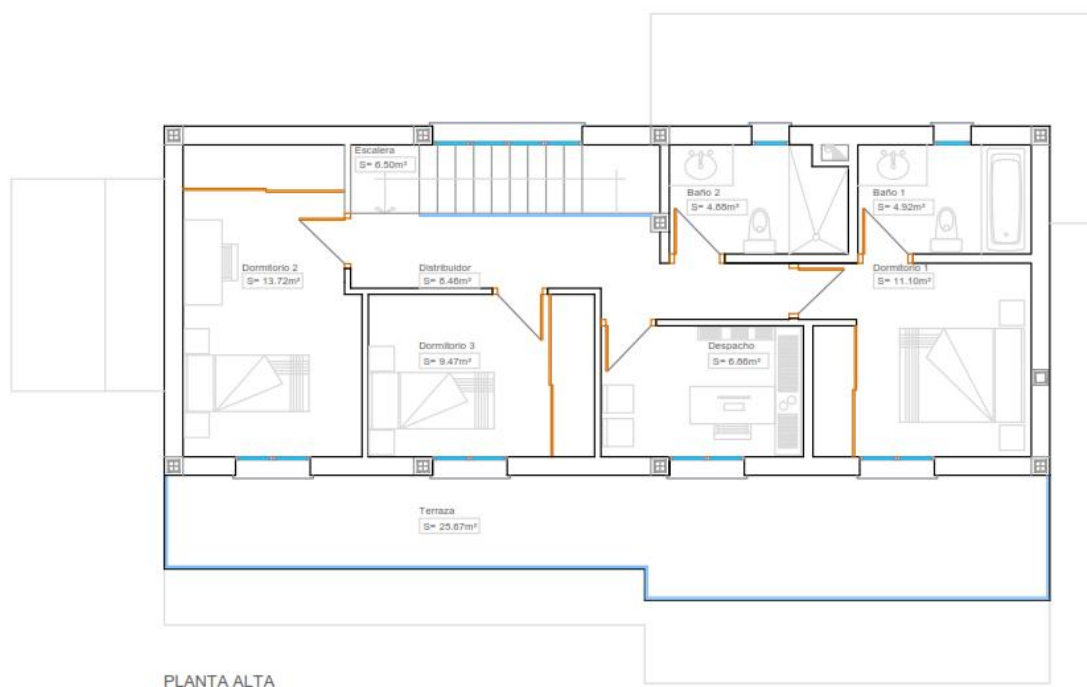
Plano de distribución de la planta alta del inmueble objeto.
